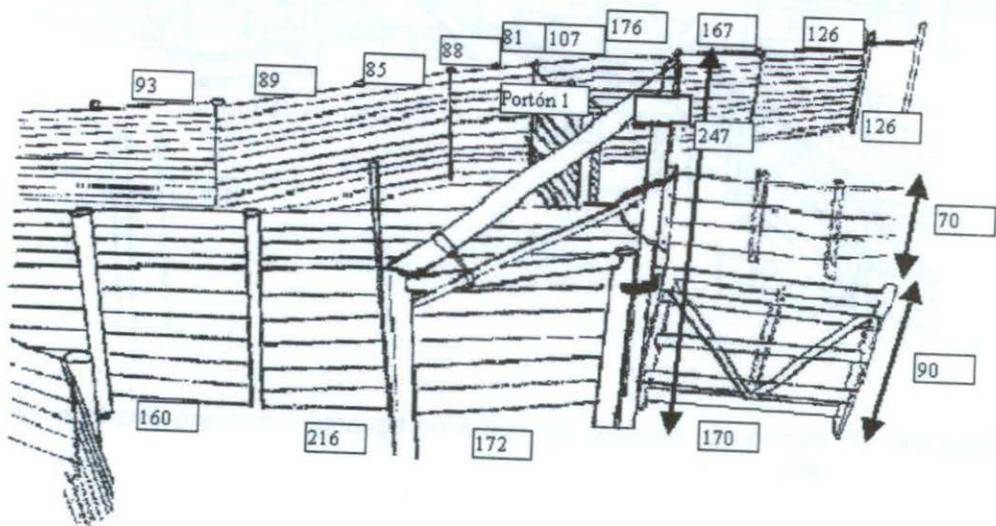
Sección C. Apiñadero y subdivisiones (medidas en cm).
